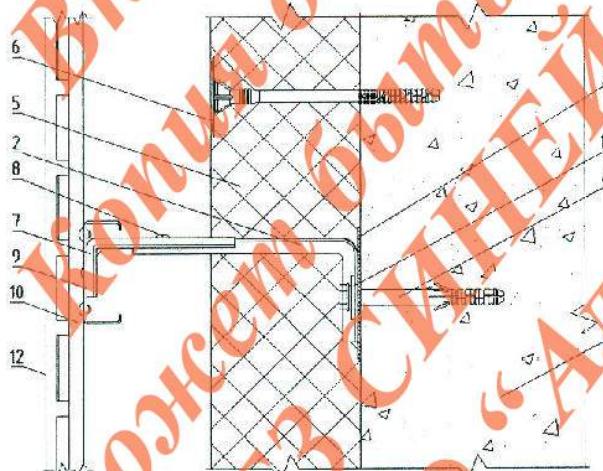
Горизонтальный разрез фасадной системы “АЛЬТ-ФАСАД-10”
